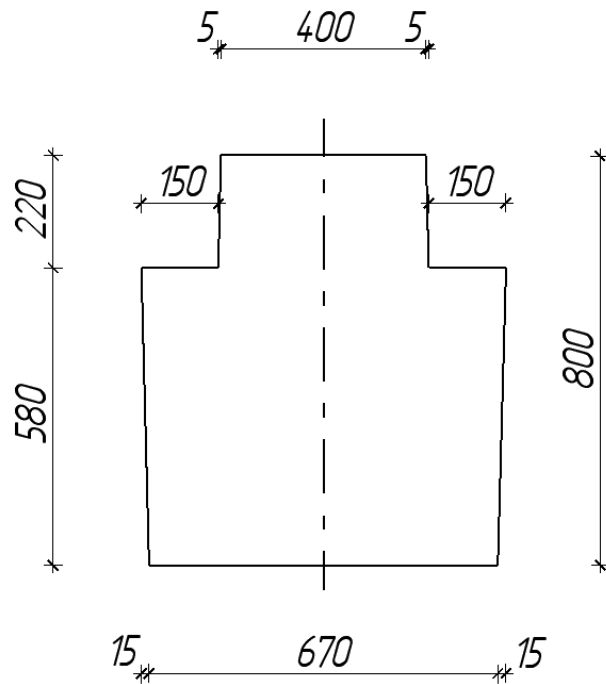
Поперечний переріз ригеля громадської будівлі
